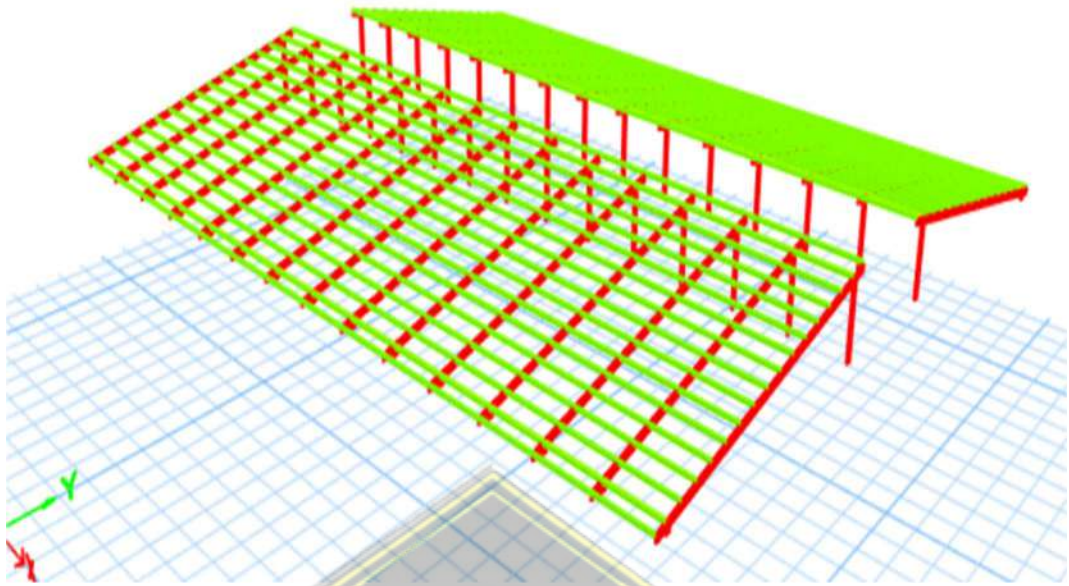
Denah Balok Lantai 1-3 Gedung B
